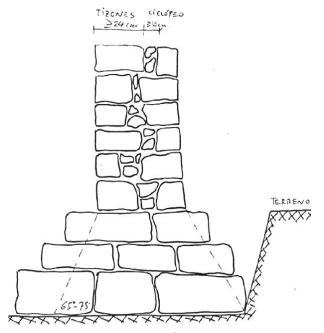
MURO DE MAMPOSTERÍA. Sección teórica de un muro de mampostería y su encuentro con la cimentación corrida. Fuente propia.
